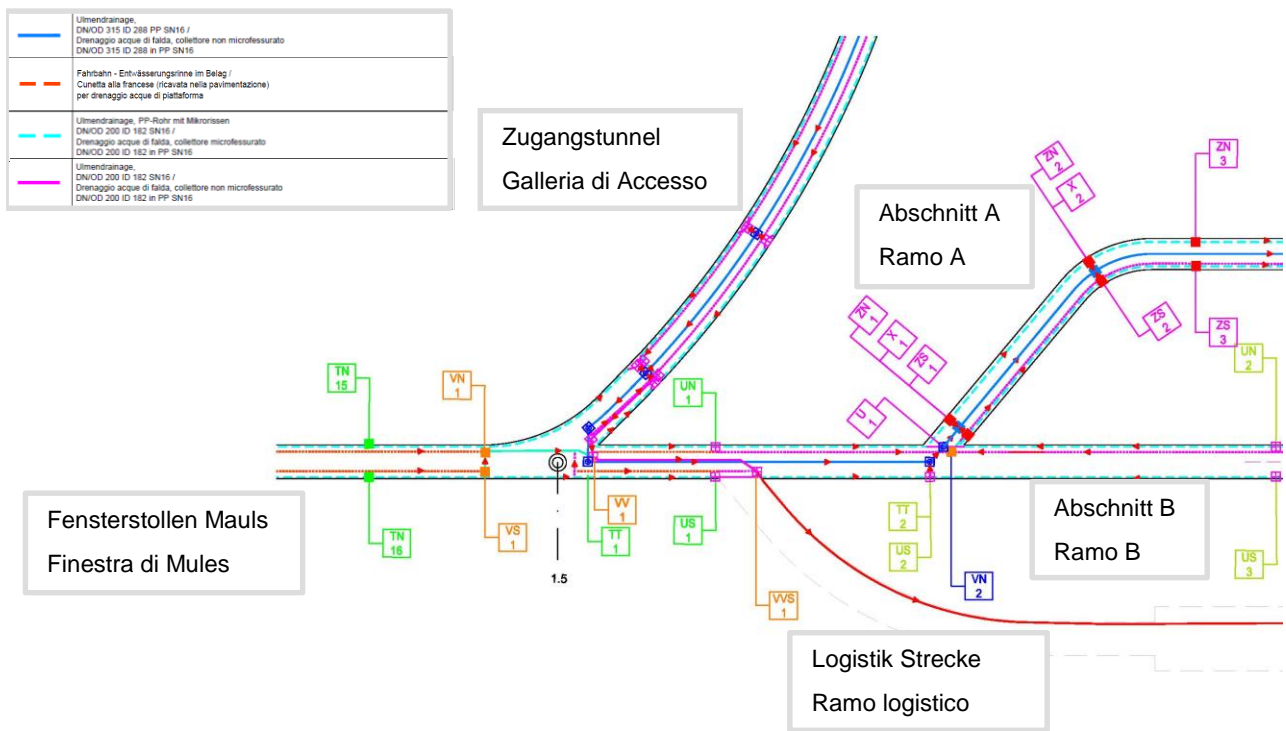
Hydraulikschema an den Anschlüssen des Zugangstunnels und der Strecke A zum Fensterstollen Mauis.
